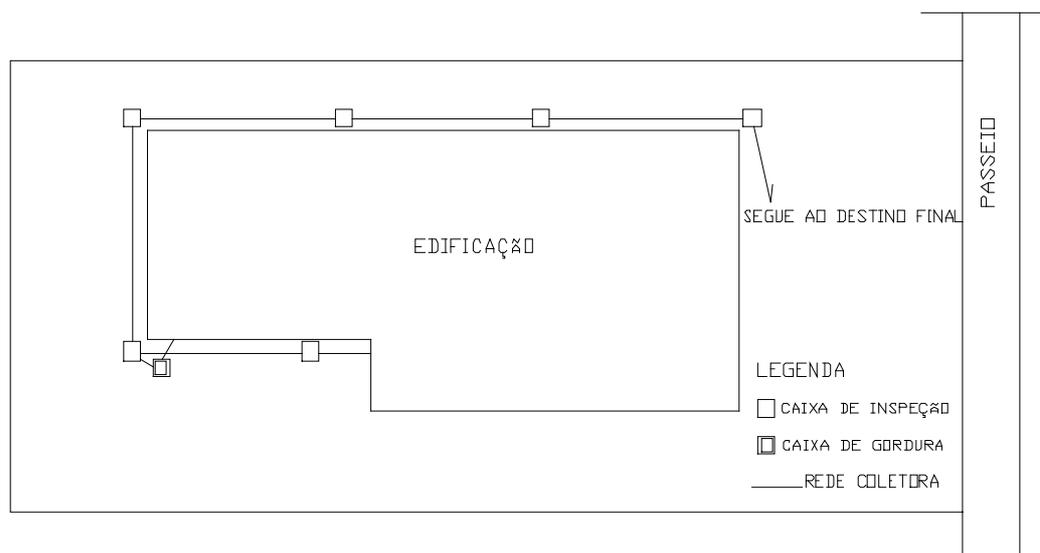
PLANTA BAIXA INSTALAÇÃO SANITÁRIA
